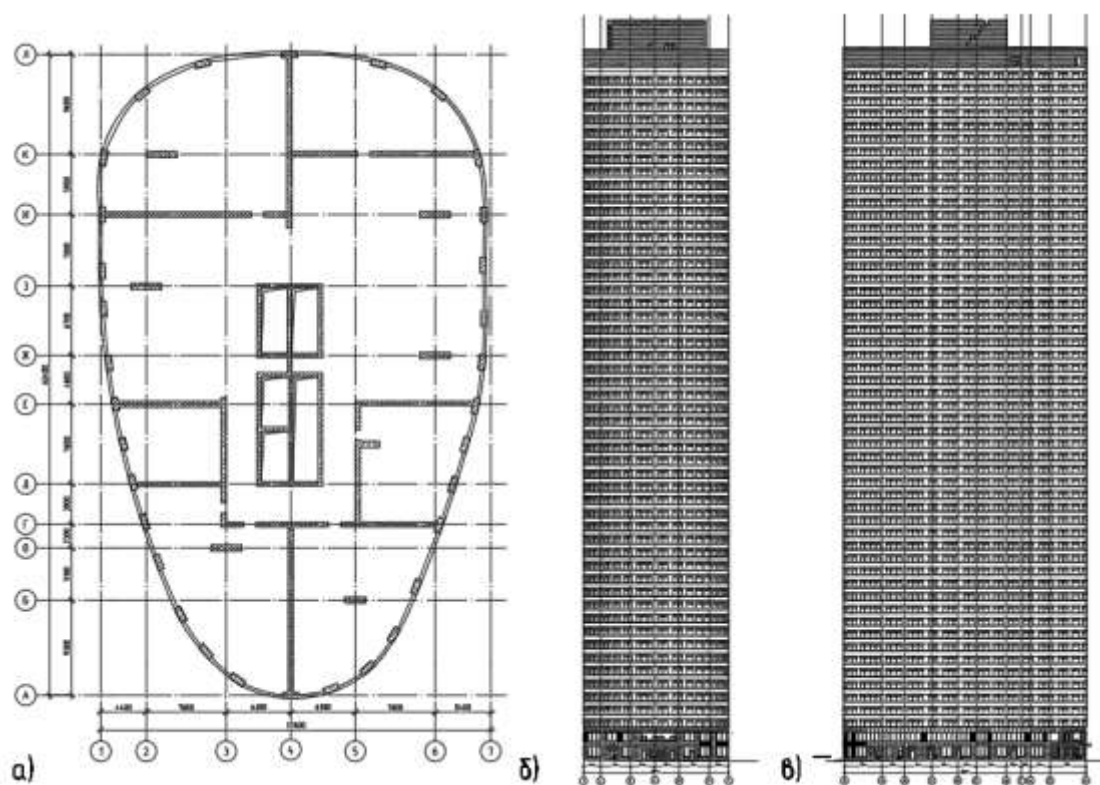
Конструктивная схема рассчитываемого здания: (а) план типового этажа; (б) фасад в осях 1–7; (в) фасад в осях Л-А (составлено авторами)
